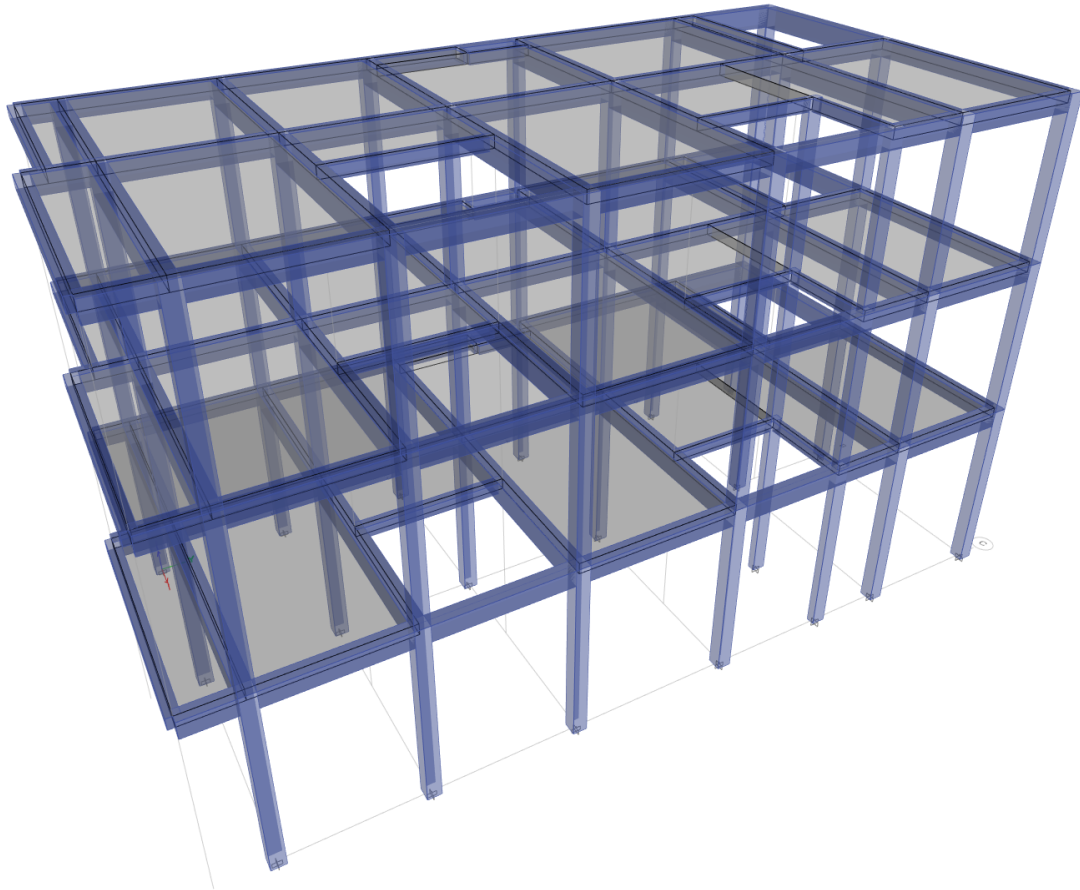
Vista 3D de la estructura de concreto armado Modelo de análisis.
